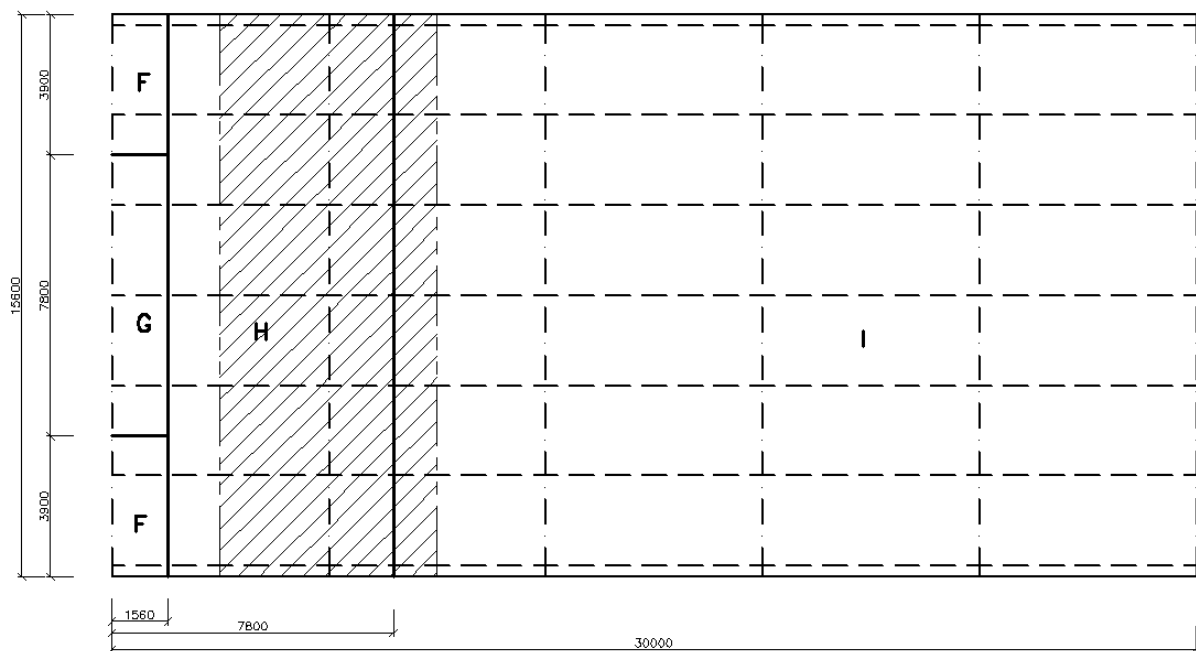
Půdorys střechy, zatížení větrem příčným na rám
